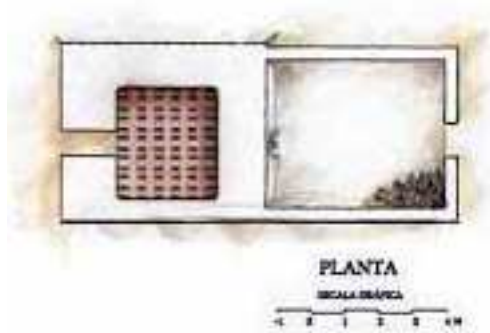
Planta 6.1.5.1-4
